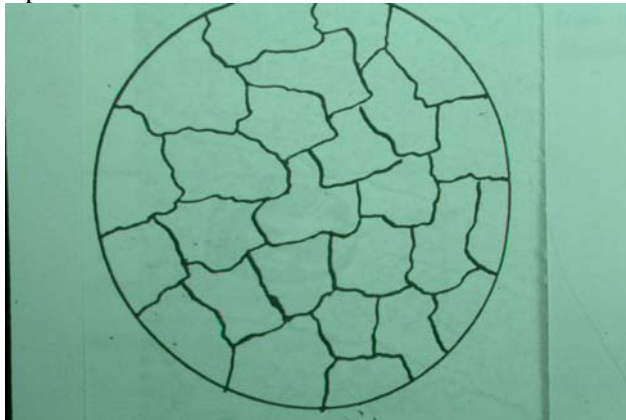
Fissuração do concreto devido a reação do cimento com o dióxido de carbono do ar.
